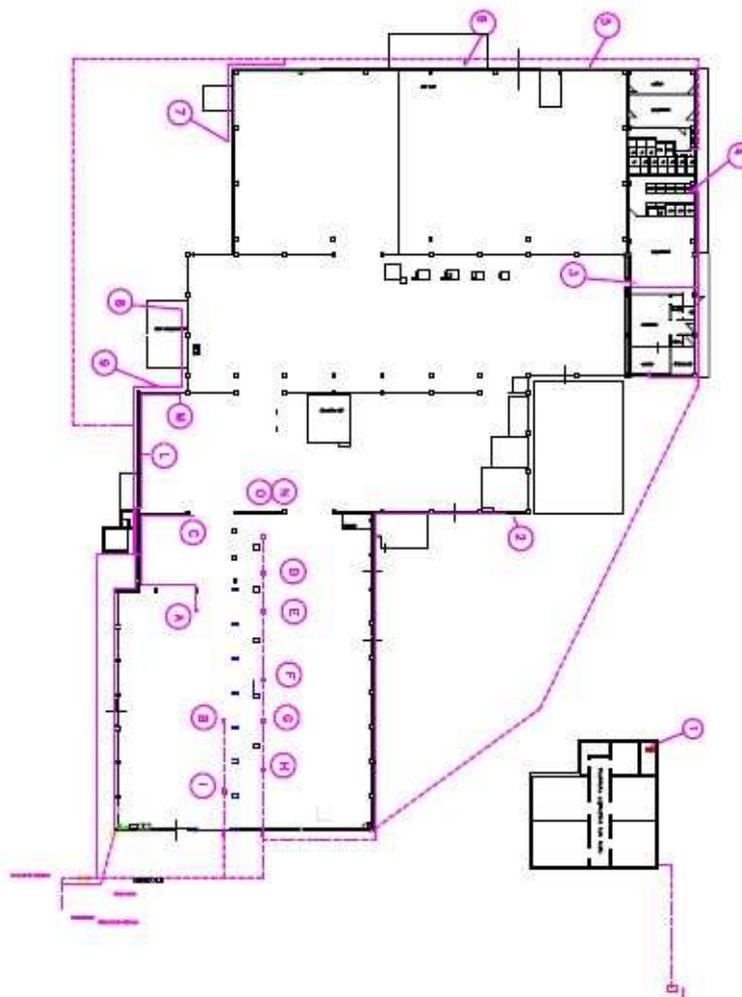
PLANIMETRIA IMPIANTI TERMICI
